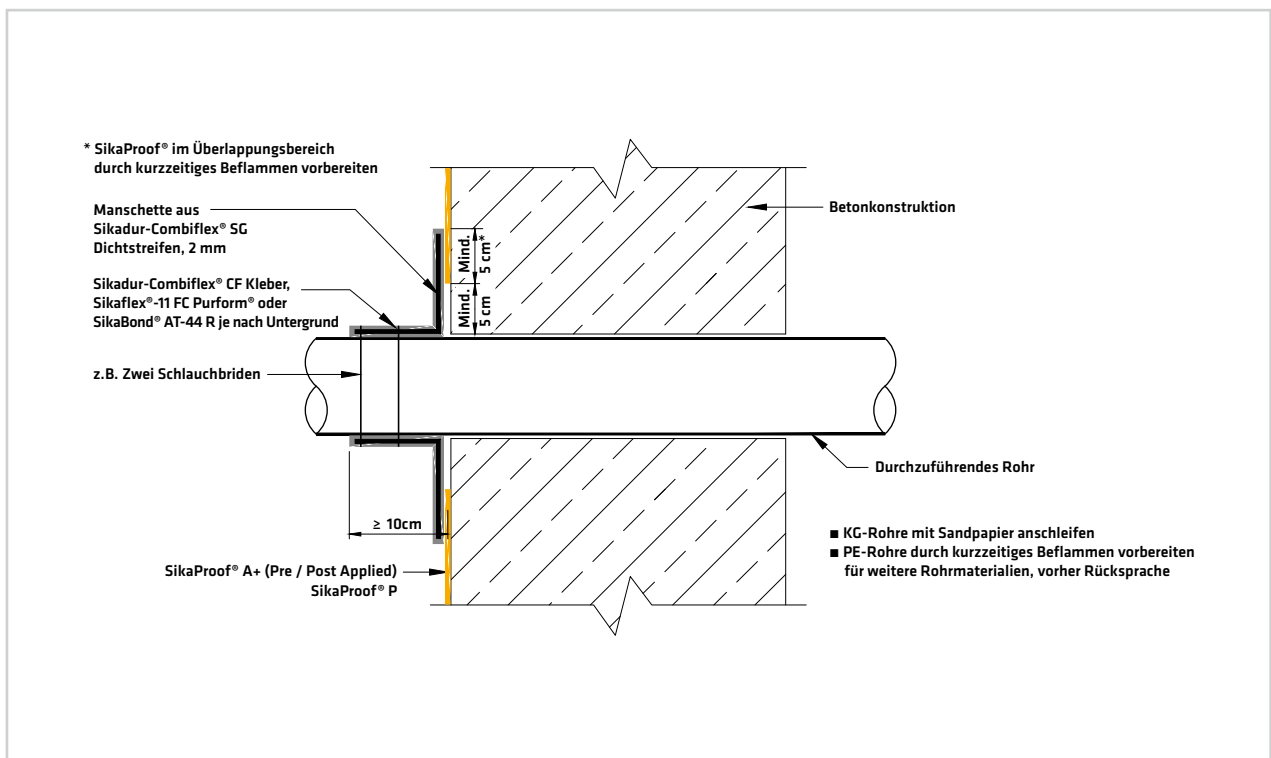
Rohrdurchführung mit Kunststoffhüllrohr (Futterrohr)
